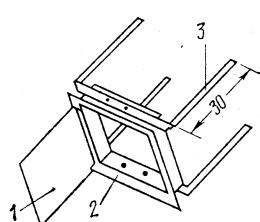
Крепление кламмеров к рамке топочной дверки: 1 — дверка; 2 — рамка; 3 — кламмеры
